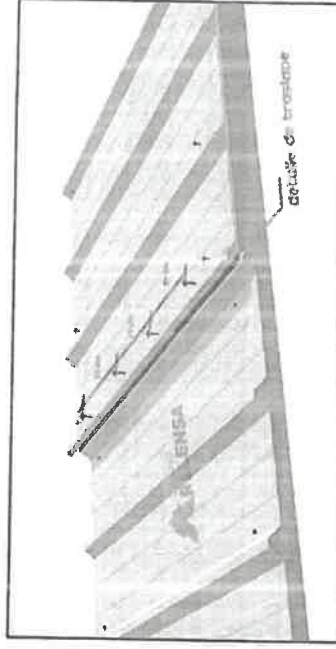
"Detalle de fijación de pernos en traslape longitudinal"
